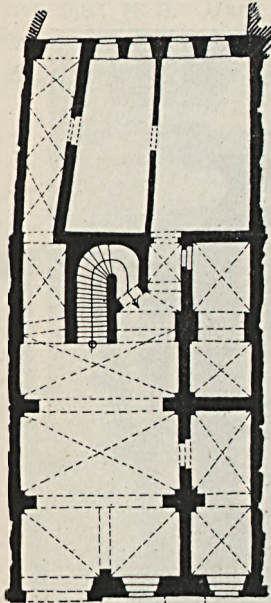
Bautzner Straße Nr. 11, Grundriß.
